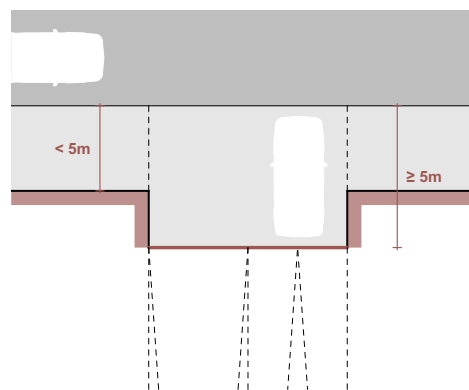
Schema-Grundriss zurückgesetzte Tore
